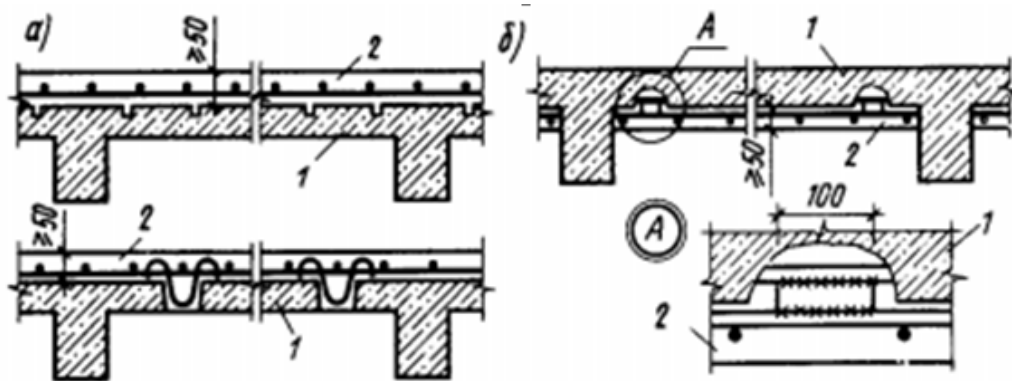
Підсилення залізобетонних плит нарощуванням зверху (а) і знизу (б): 1-плита; 2-новий бетон
